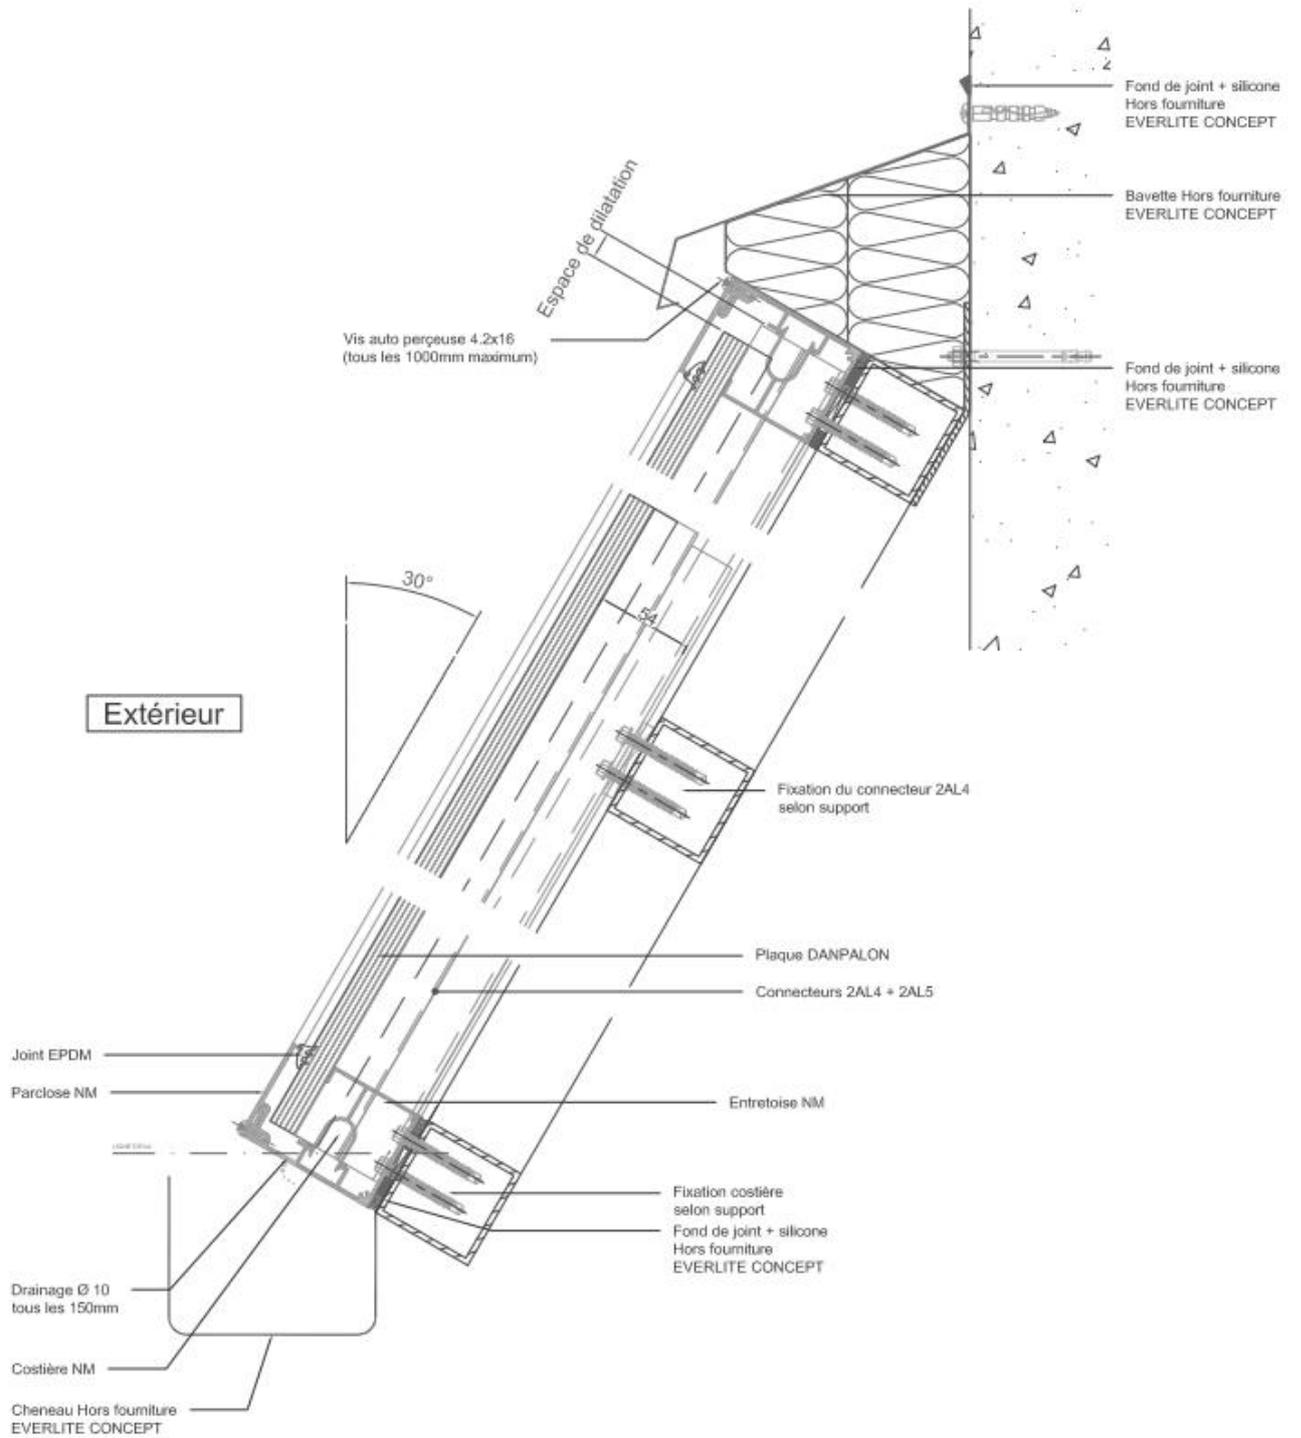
Coupe verticale sur connecteur aluminium 2AL4/2AL5 – Système DANPALON® sur SHED
